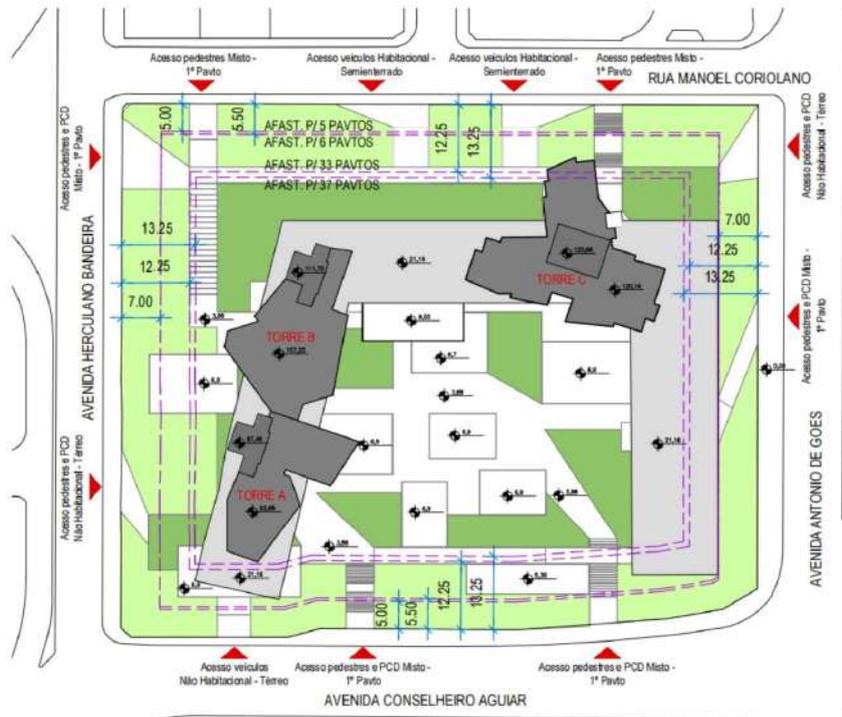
Planta do pavimento térreo, indicando os acessos ao empreendimento.
